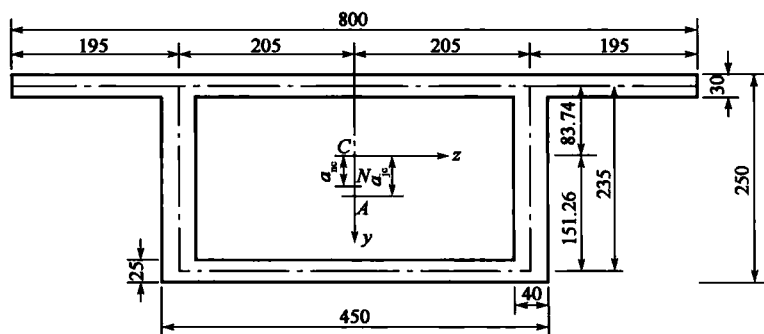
某矩形箱梁截面图(尺寸单位:cm)
